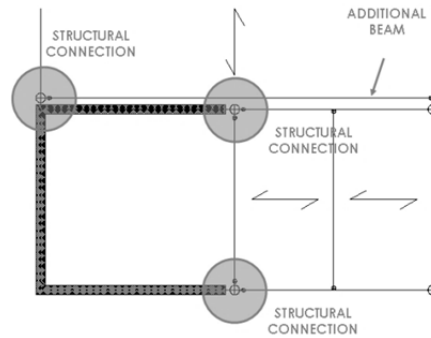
Exemple de connexion entre structure métallique et mur en béton, découplage des charges verticales et horizontale (vue en plan).
